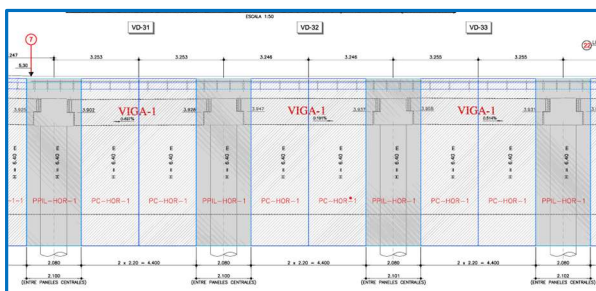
Definición paneles centrales (PC) y paneles de pilote (PPIL). Extracto del plano de prefabricación.
